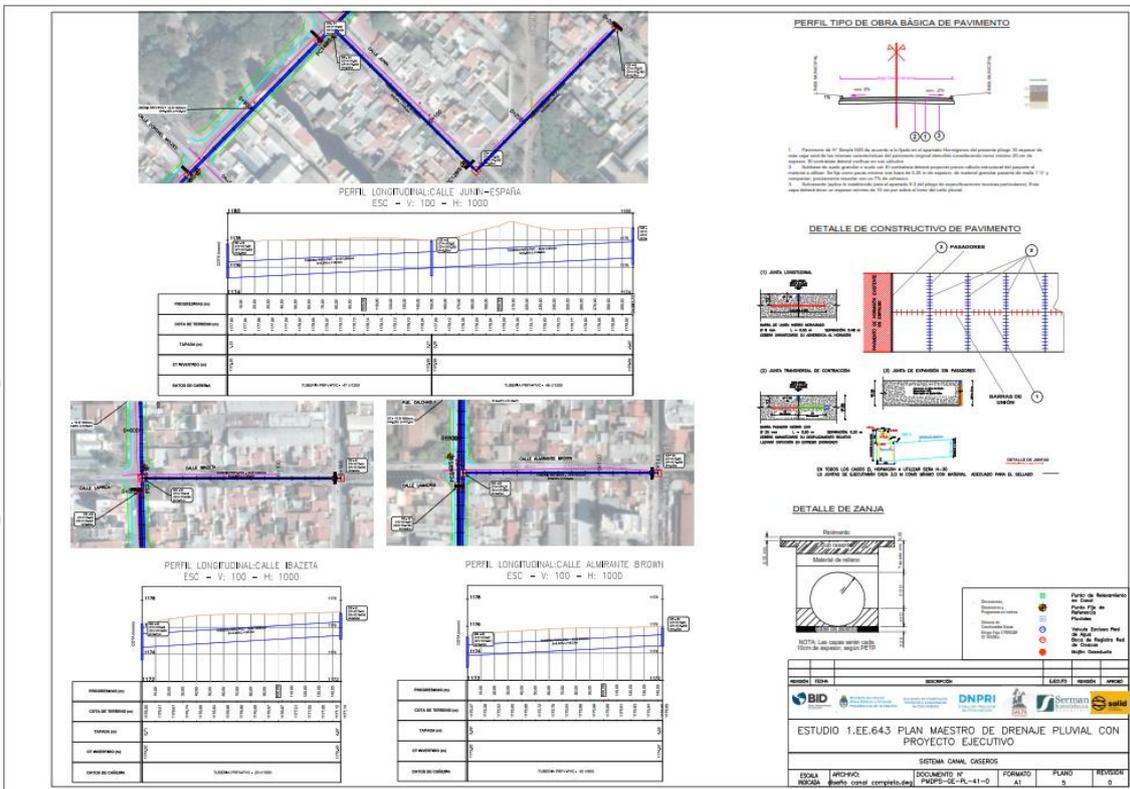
Plan Maestro de drenaje Pluvial – Canal secundario calle Caseros
